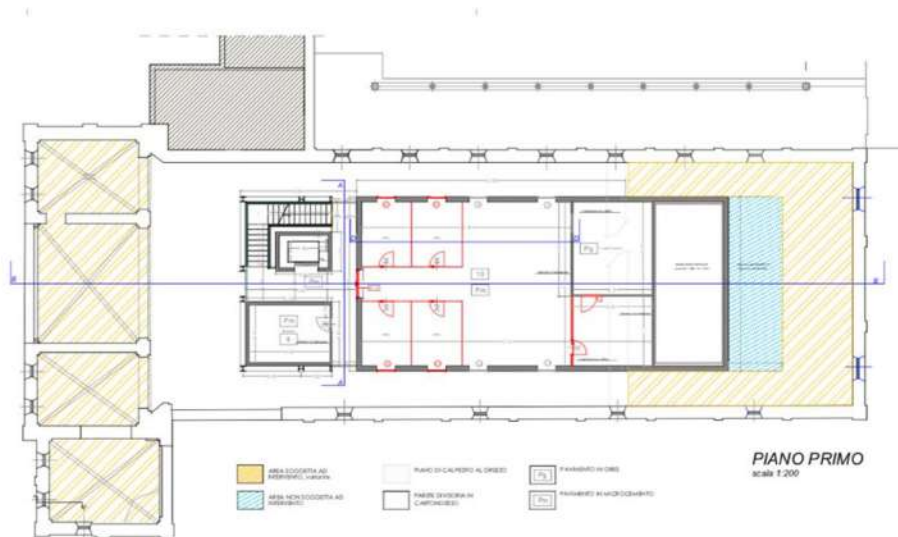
pianta della Chiesa con l'inserimento delle nuove realizzazioni al primo piano.
